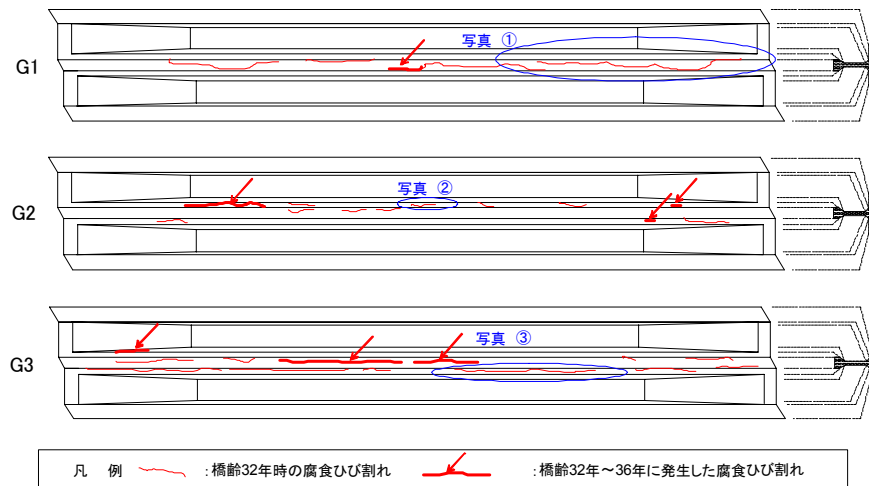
須井川橋 腐食ひび割れ分布とひび割れ状況写真
